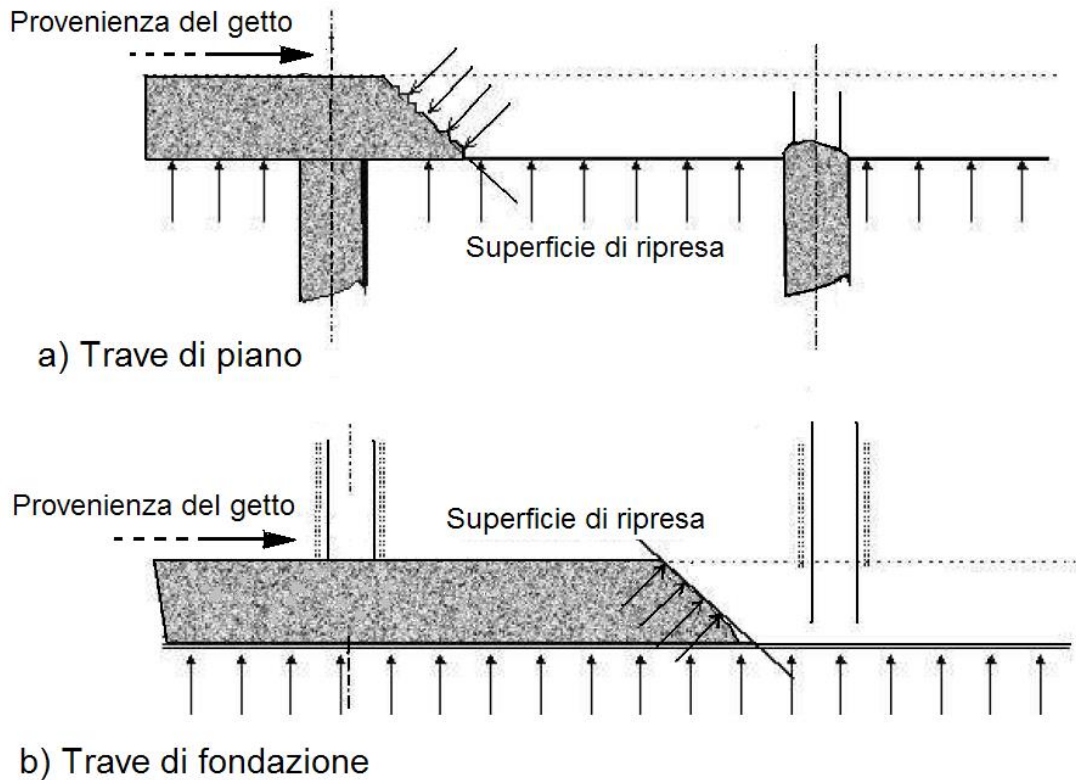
Modalità di ripresa del getto in travi di piano e di fondazione
